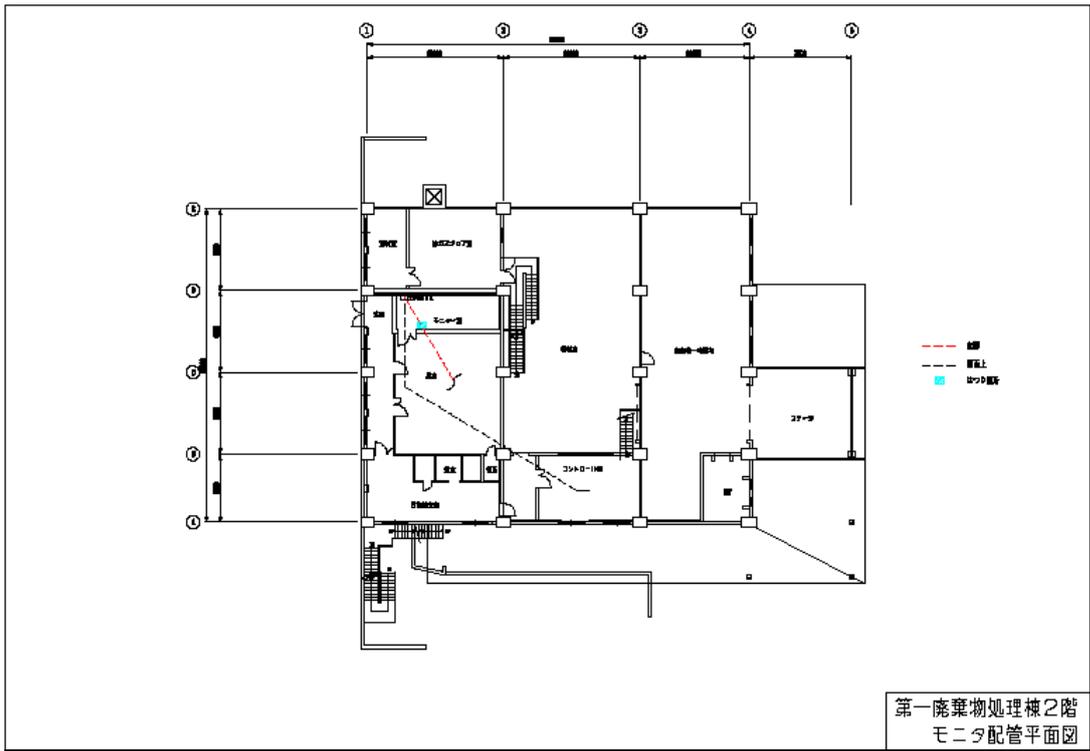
第 1 廃棄物処理棟 2 階モニタ配管平面図
